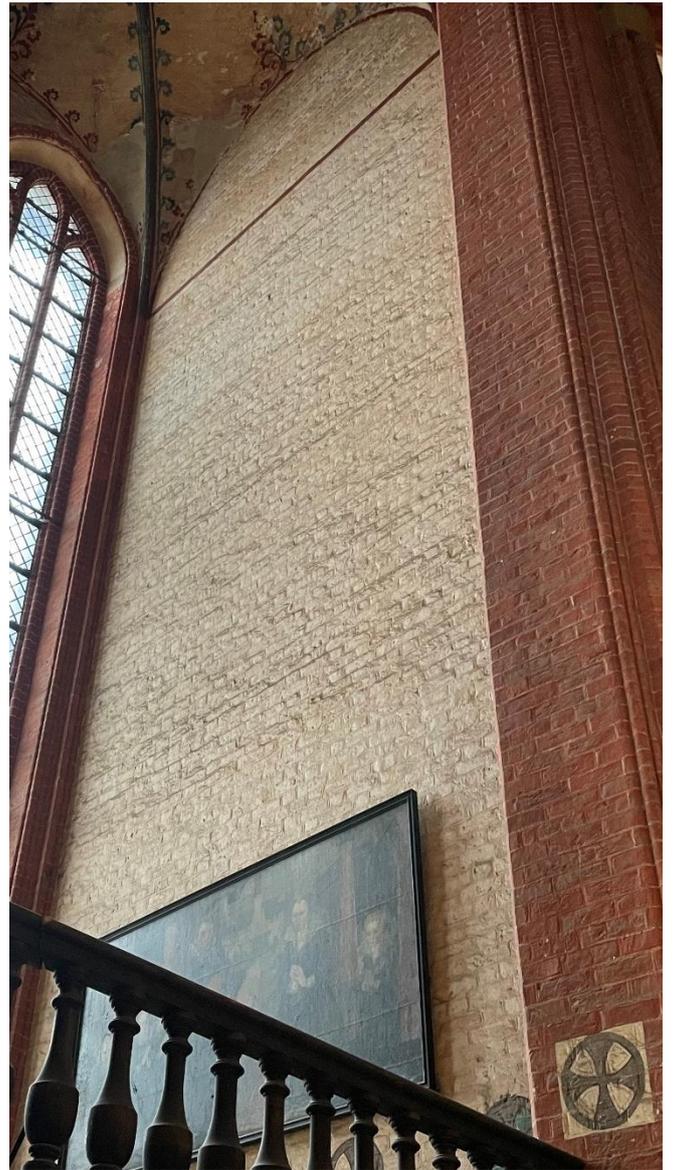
zu Punkt 2.4: Fassung Ostwand erheblich staubverschmutzt, Retusche Begleitstrich.
